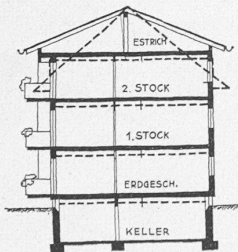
u. 12. Schnitt und Ansicht einer Bebauung mit drei Vollgeschossen und nicht ausgebautem Dachstock. Gestrichelt: Schnitt der ausgeführten Bauten mit ausgebautem Dach
